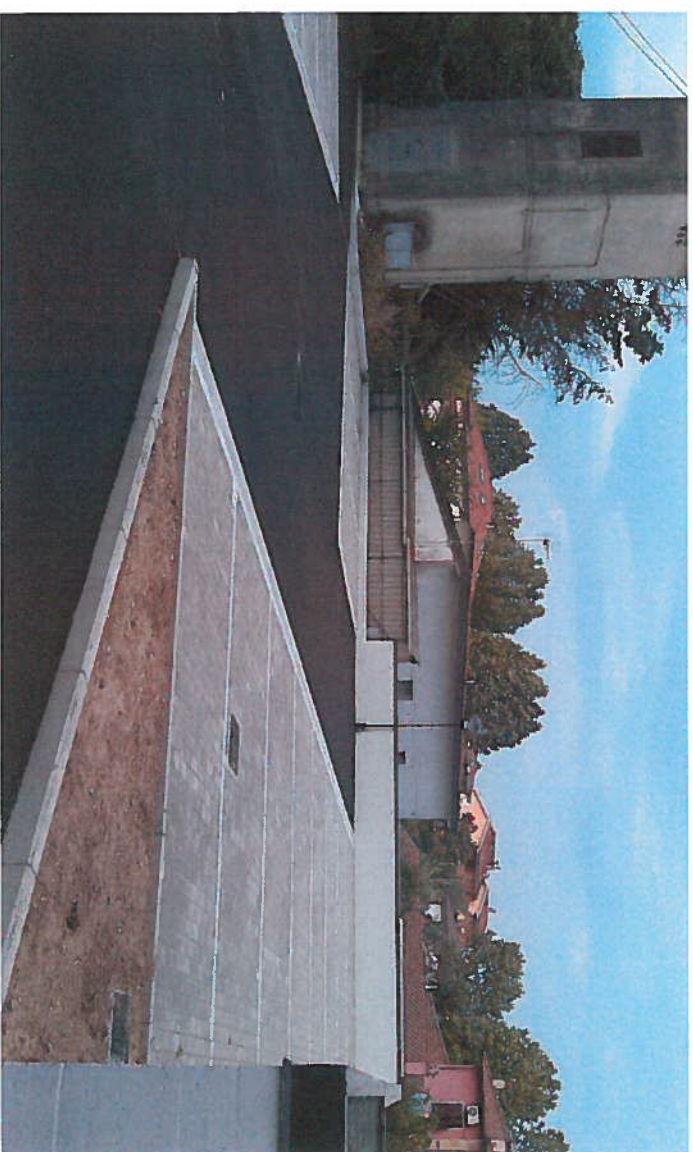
prospetto frontefabbricato particolare rampa accesso Scala B
